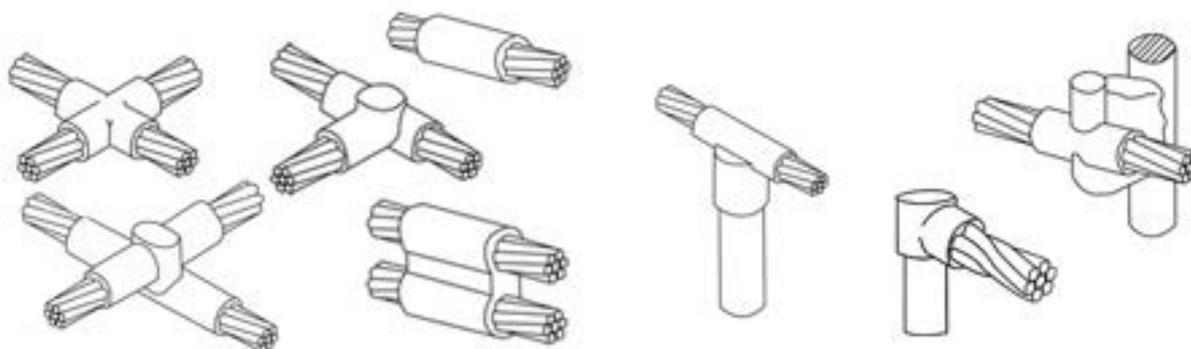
Exemplos de Solda Exotérmica a ser executada nas conexões da malha de aterramento, cabo-cabo e haste-cabo.
